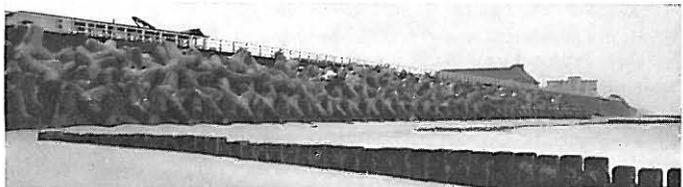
Stahlbetonspundwand als Bühne, im Hintergrund Tetrapoden
